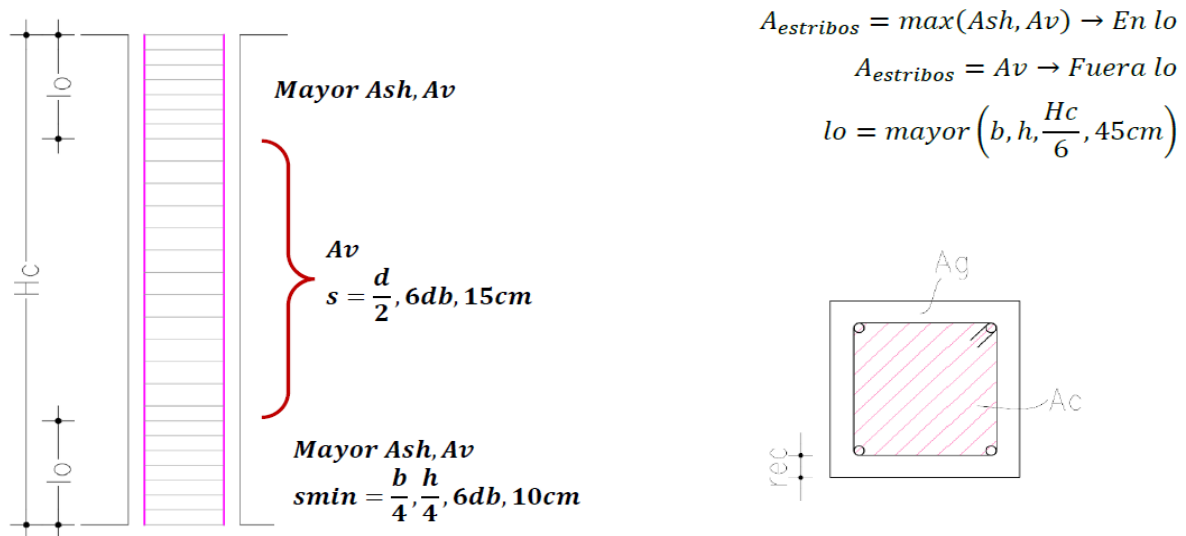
Separación de estribos de columna / Área bruta y confinada.
